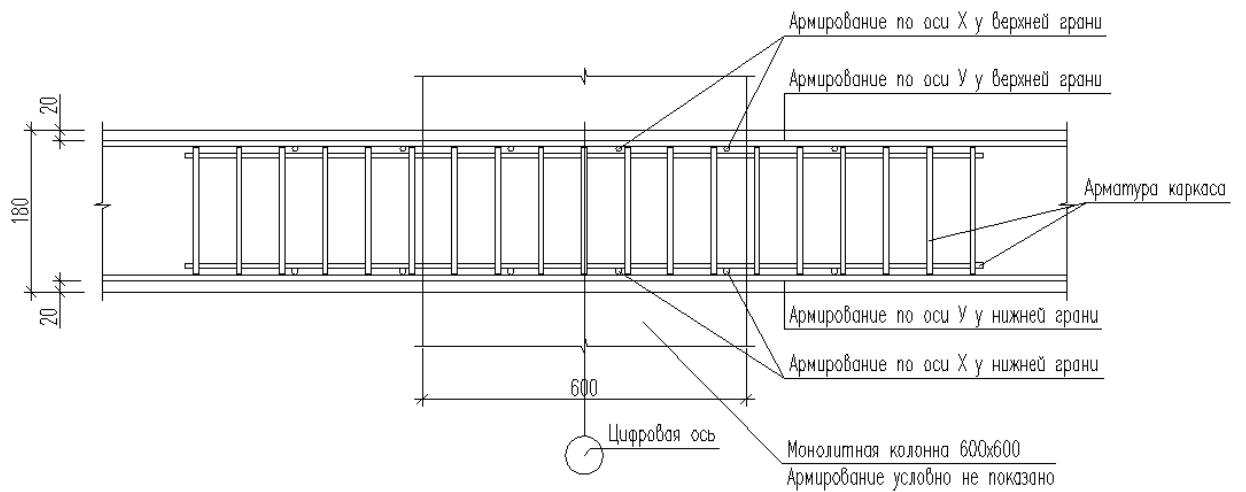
Схема расположения арматуры в плите.
